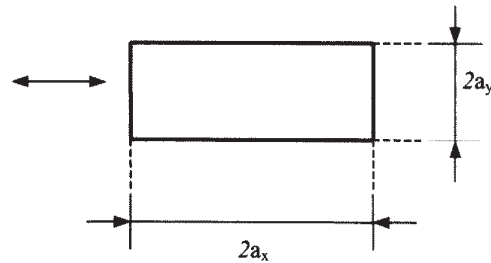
Definition der Abmessungen eines rechteckigen Pfeilerquerschnitts
